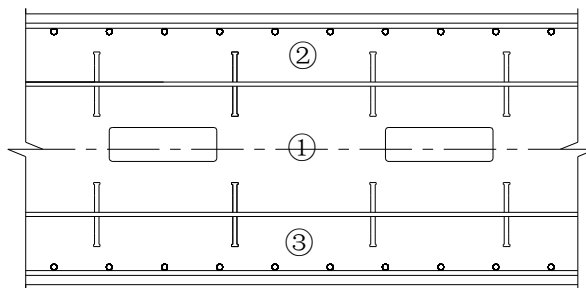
双层钢板混凝土剪力墙混凝土浇筑示意
